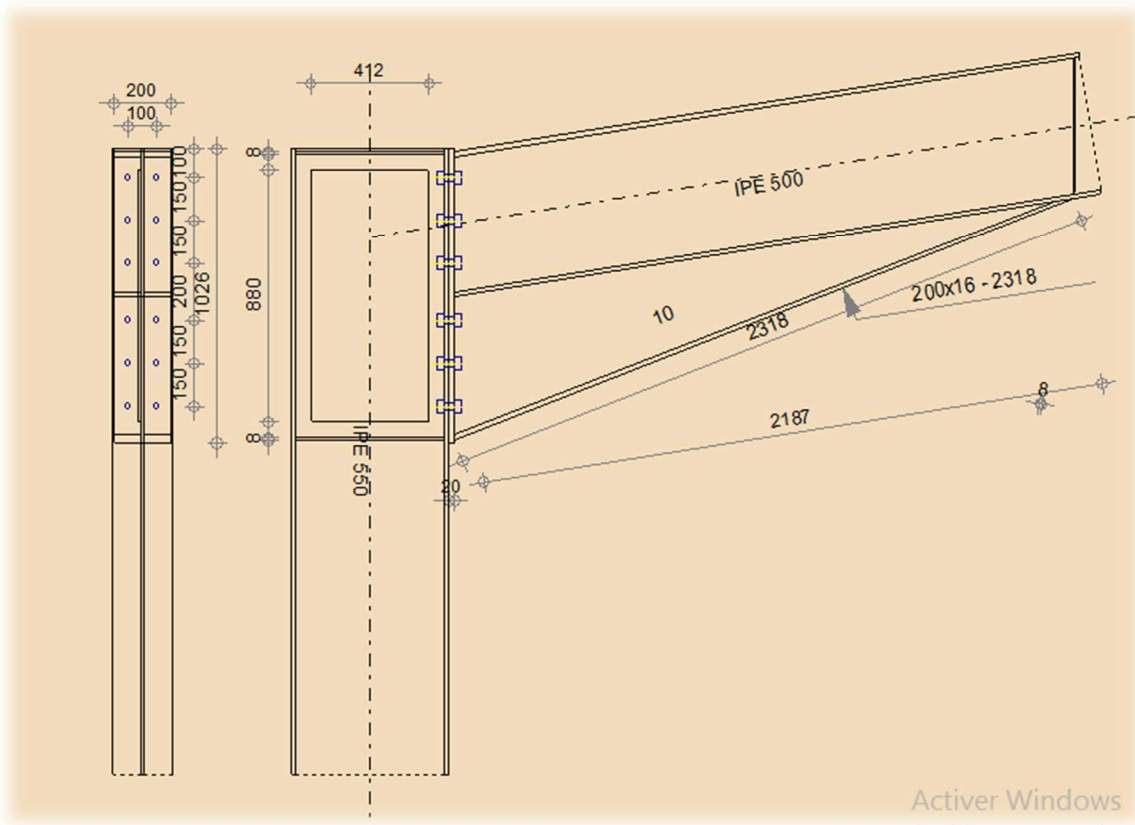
Détail d'assemblage poteau - traverse (IPE550-IPE500)
